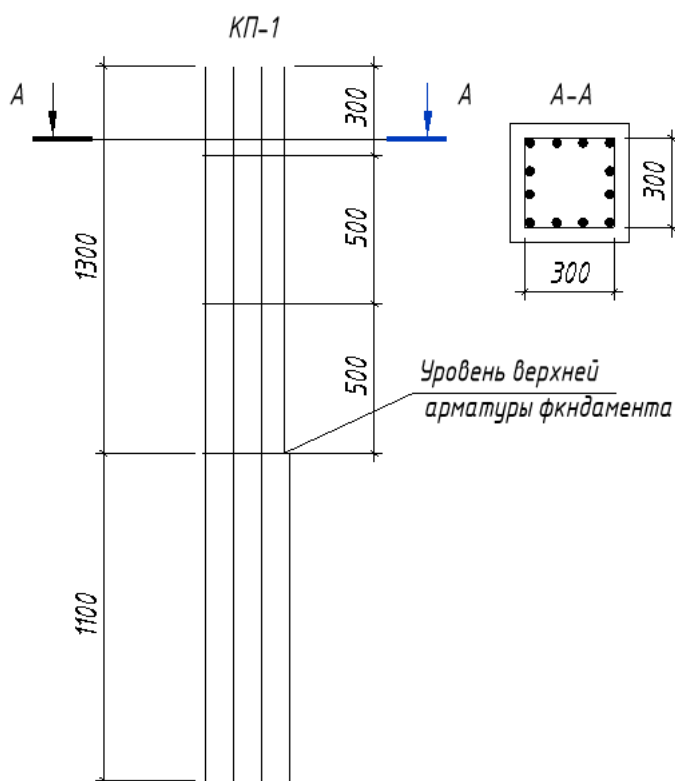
Соединение монолитной железобетонной колонны с монолитным фундаментом
